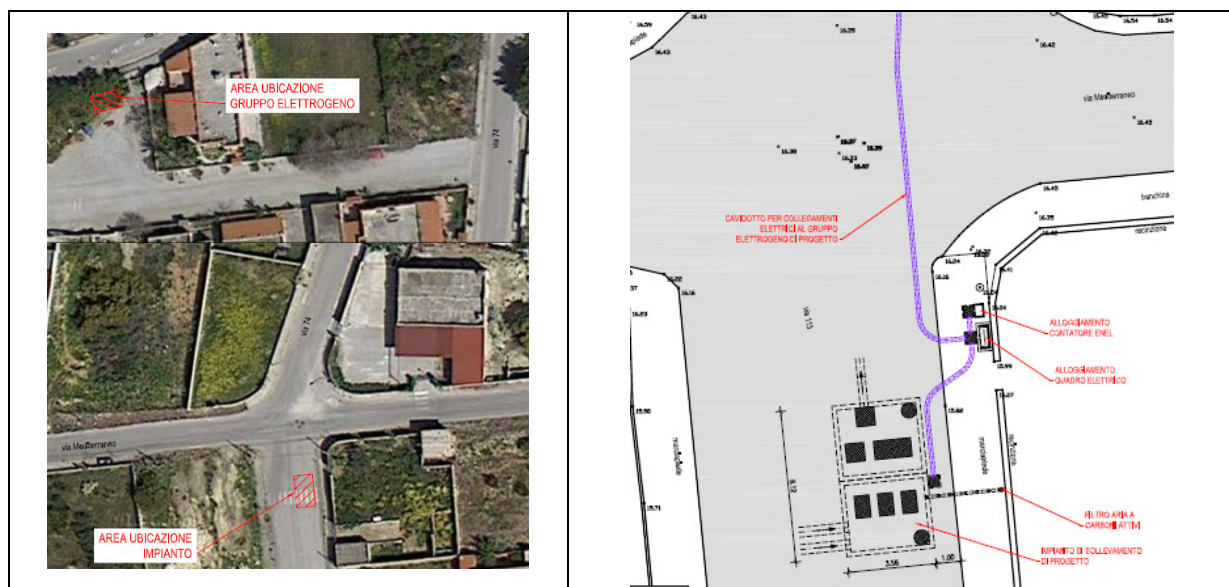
Localizzazione territoriale dell'impianto e planimetria con le sistemazioni previste.
